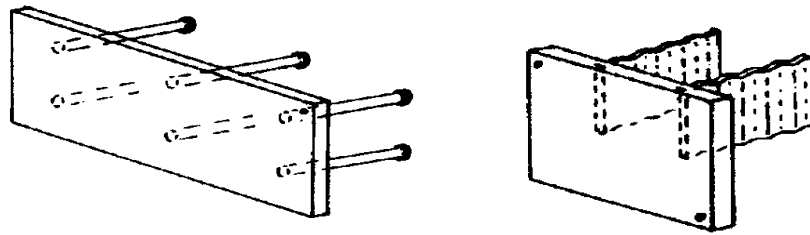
Placas de soldadura fijada con tacos y acero plano ondulado.
